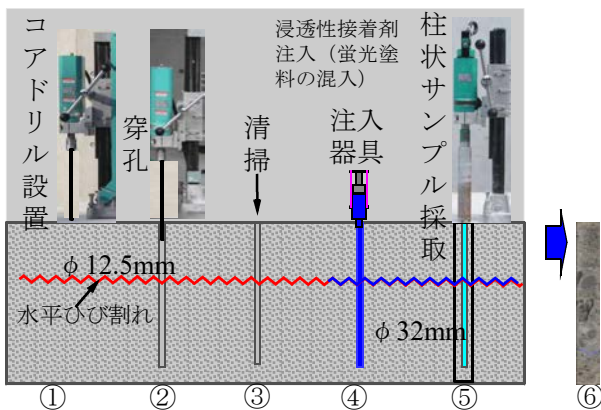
柱状サンプルによる水平ひび割れ診断
